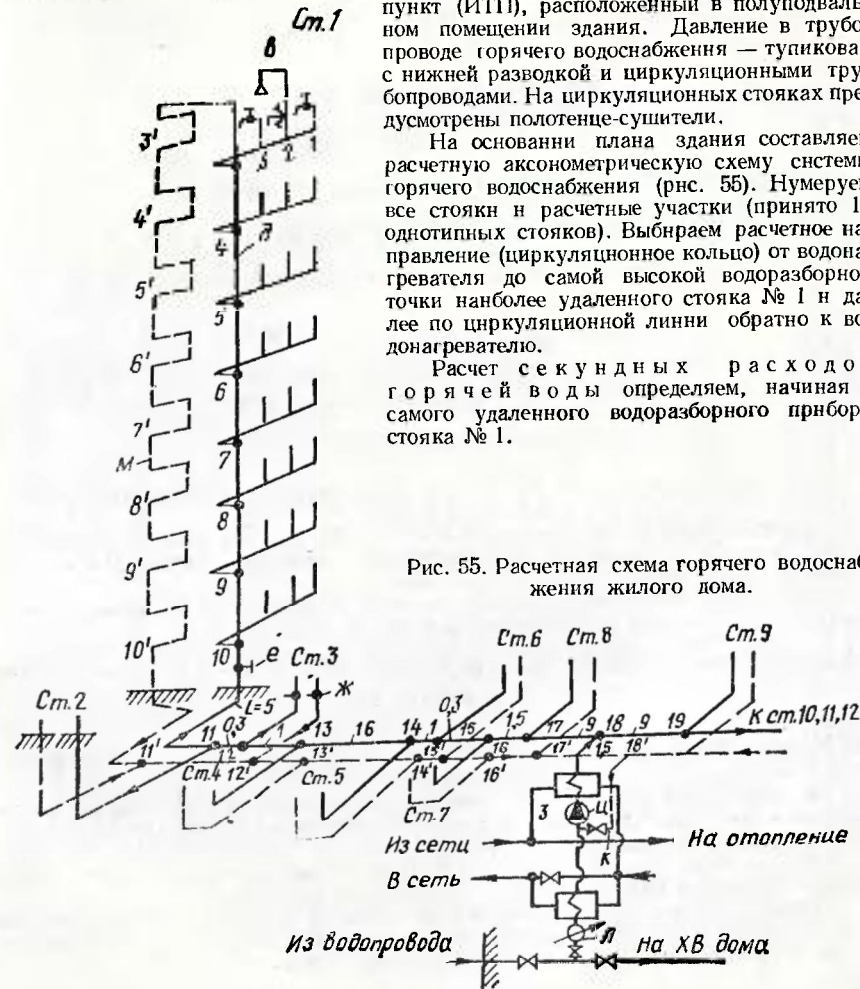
Расчетная схема горячего водоснабжения жилого дома.
